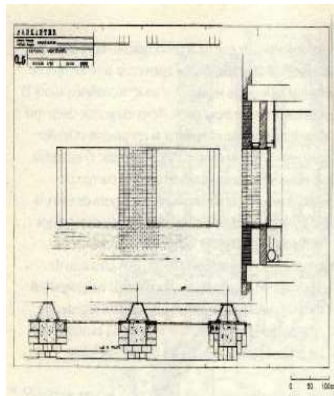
Imagen del detalle constructivo de los huecos en fachada del proyecto original de la Sede de Bankinter. Rafael Moneo.
